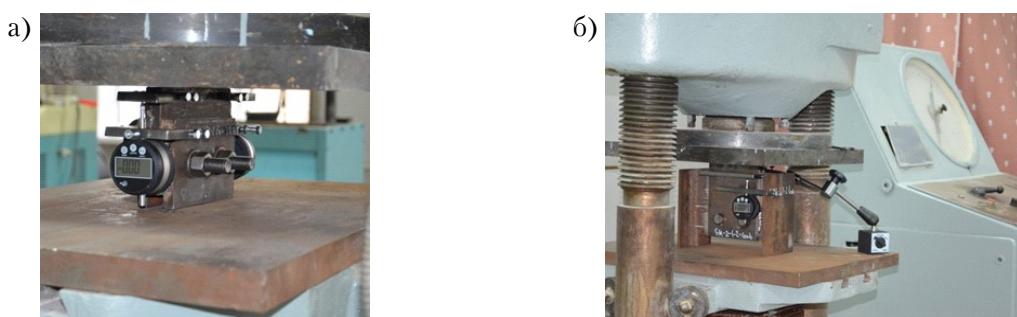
Общий вид образцов в ходе испытаний: а) образец группы SR; б) образец группы SM.
